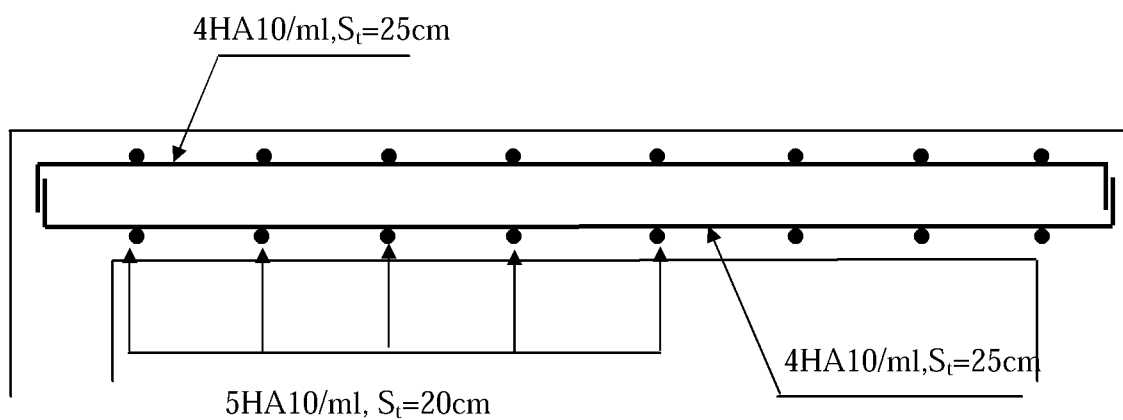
Plan de ferrailage de la salle machine suivant y-y.
